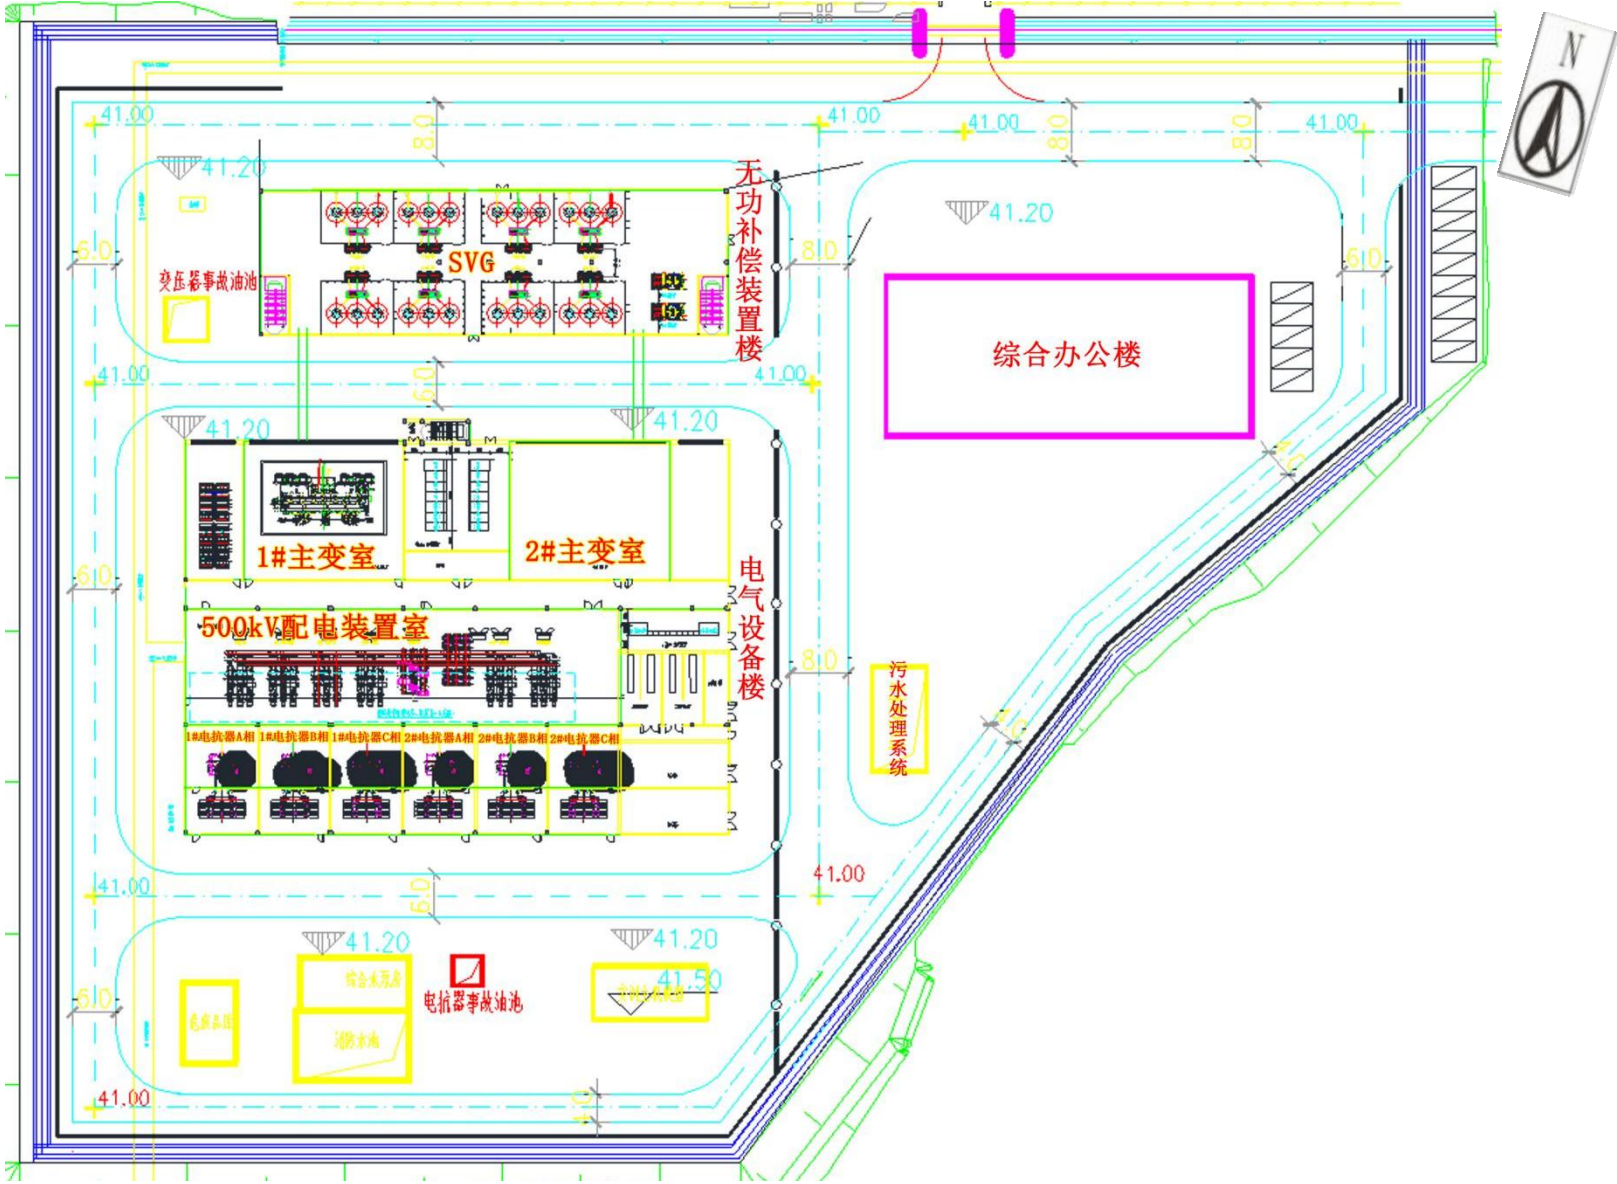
(b) 陆上集控运维中心总平面布置示意图
